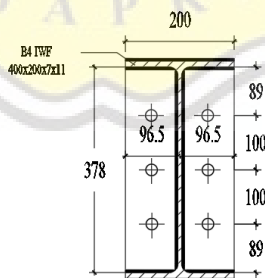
Daerah Las Kolom Dan Balok Induk
